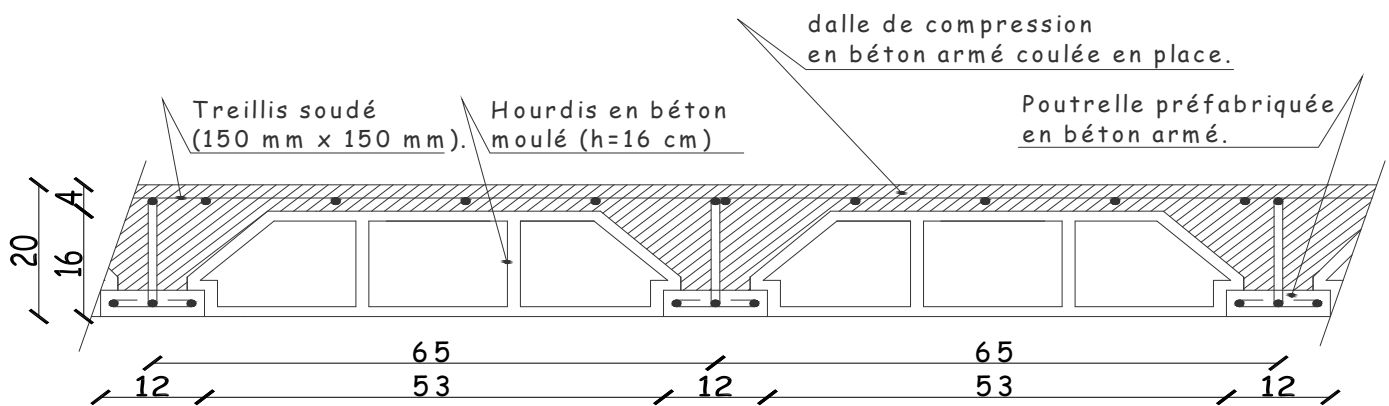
Plancher en béton armé avec poutrelles et hourdis (Plancher semi-préfabriqué)
